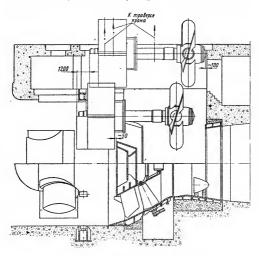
Схема установки укрупненного блока агрегата на место.
